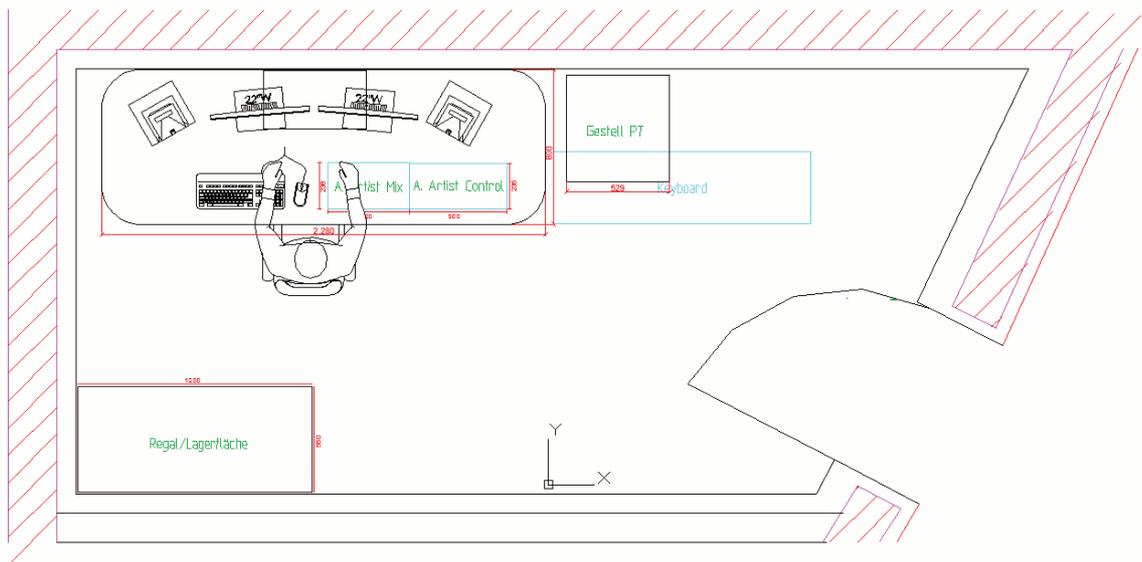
Grundriss des Layout- Arbeitsplatzes
